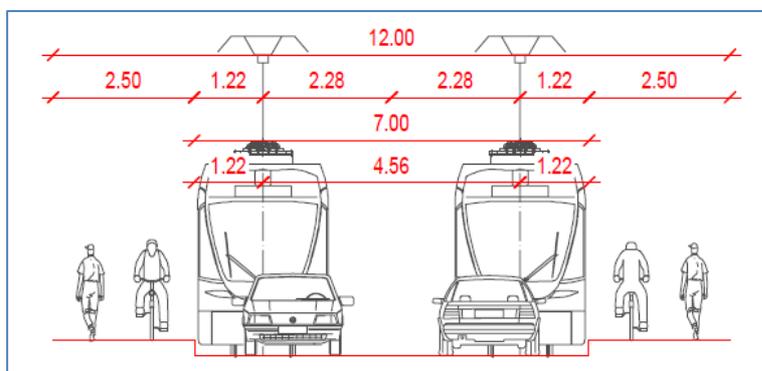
Schemaquerschnitt Abschnitt Mühle / Knoten Hauptstrasse – Bahnhofstrasse
